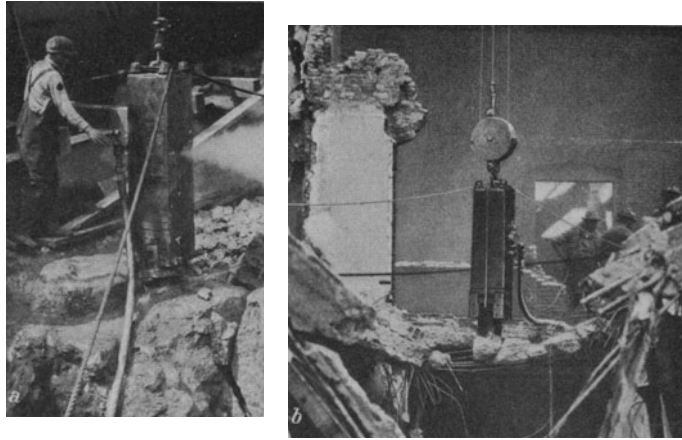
Pfahlhämmer bei Abtragarbeiten. a) Zertrümmern eines Betongrundwerkes, b) Zertrümmern einer Eisenbetondecke. (McKirnan Terry Corp., New York.)
